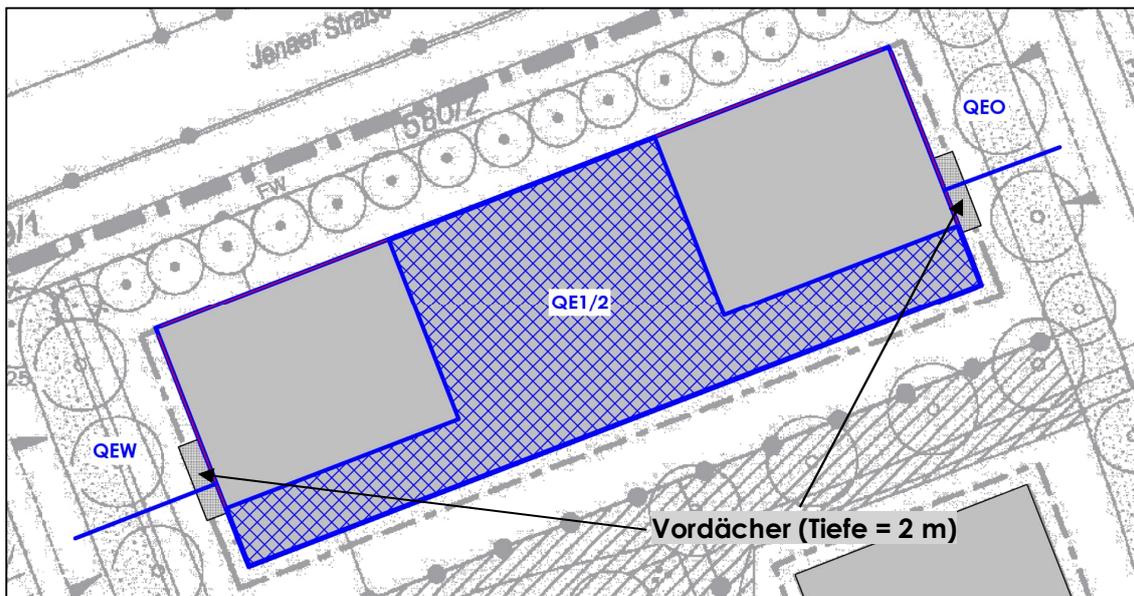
Lageplan mit Darstellung der Quartiersgarage mit Zufahrtbereichen und den als Schallschirm berücksichtigten Vordächern
